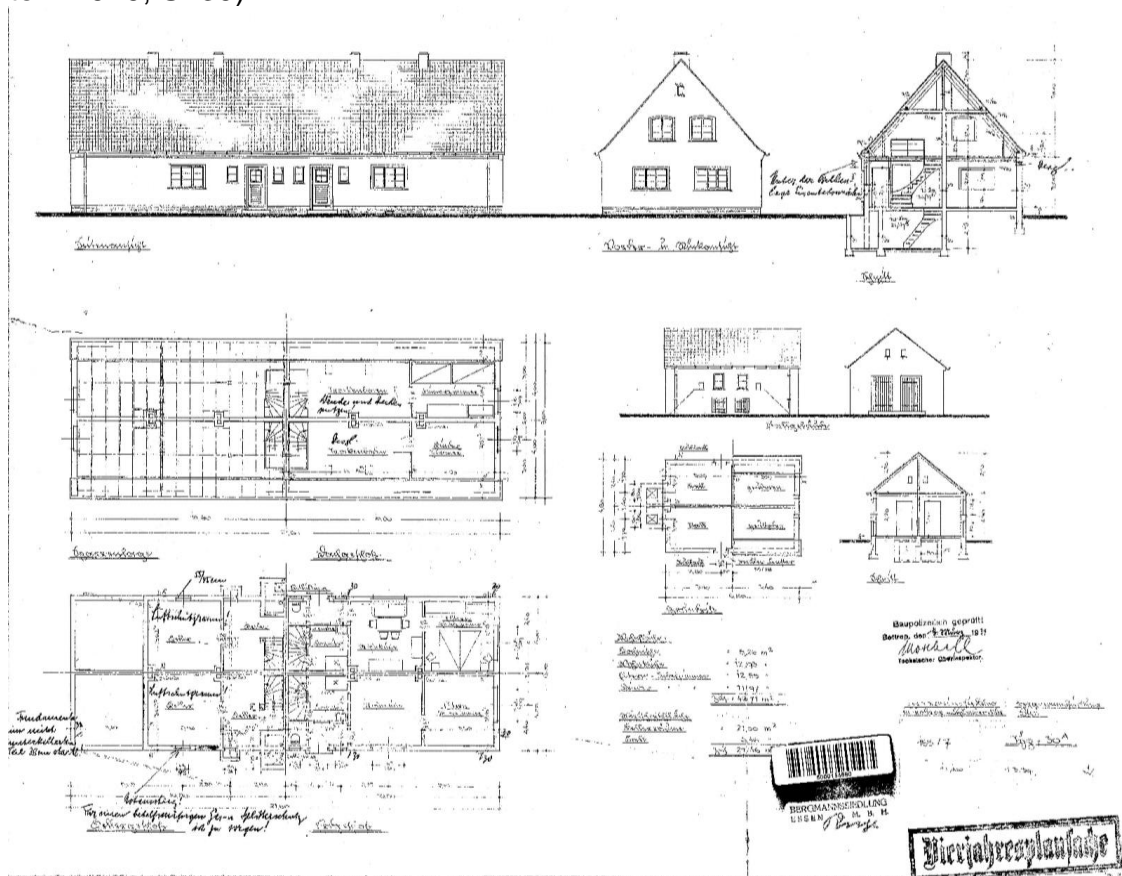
Pläne zum so genannten Kreuzgrundriss Typ 30 A (Typ D)
